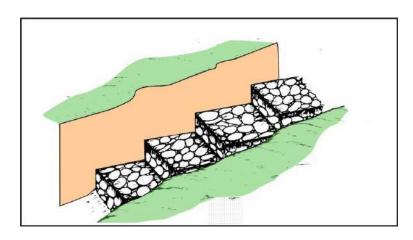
Protección del lecho de la quebrada con muros escalonados (andenes), utilizando bloques de roca o concreto armado.
